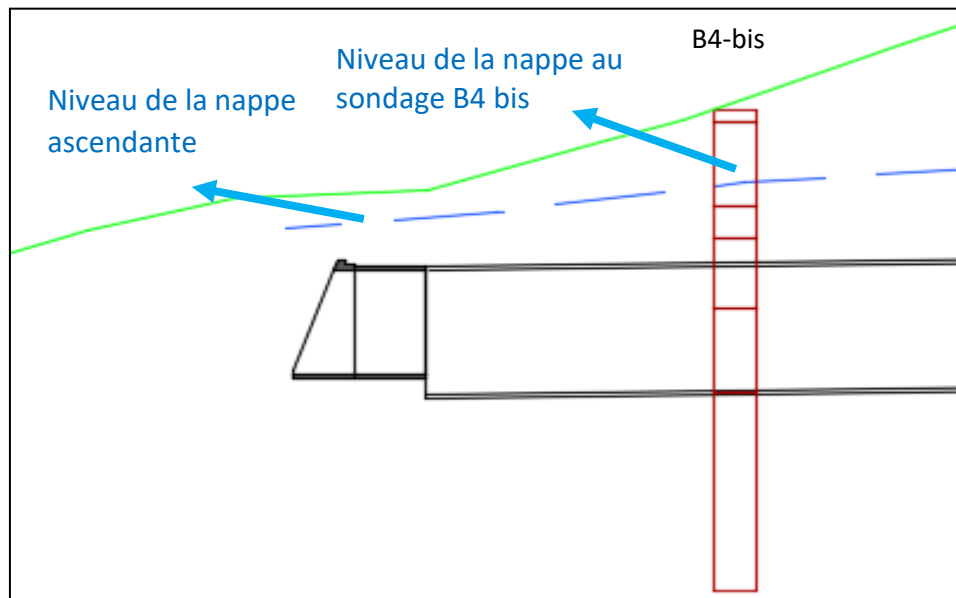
Coupe géologique de l'entrée du tunnel (profil en long)
